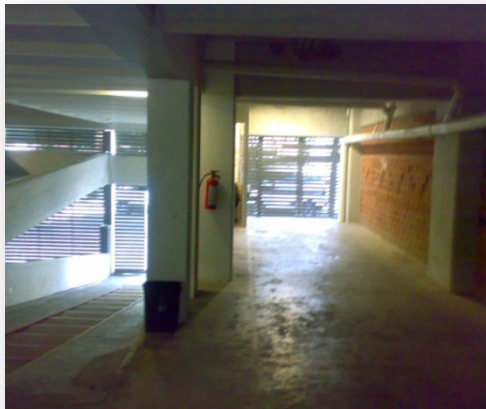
Edificio con sistema de piso de transferencia formado por losa maciza y vigas secundarias.
